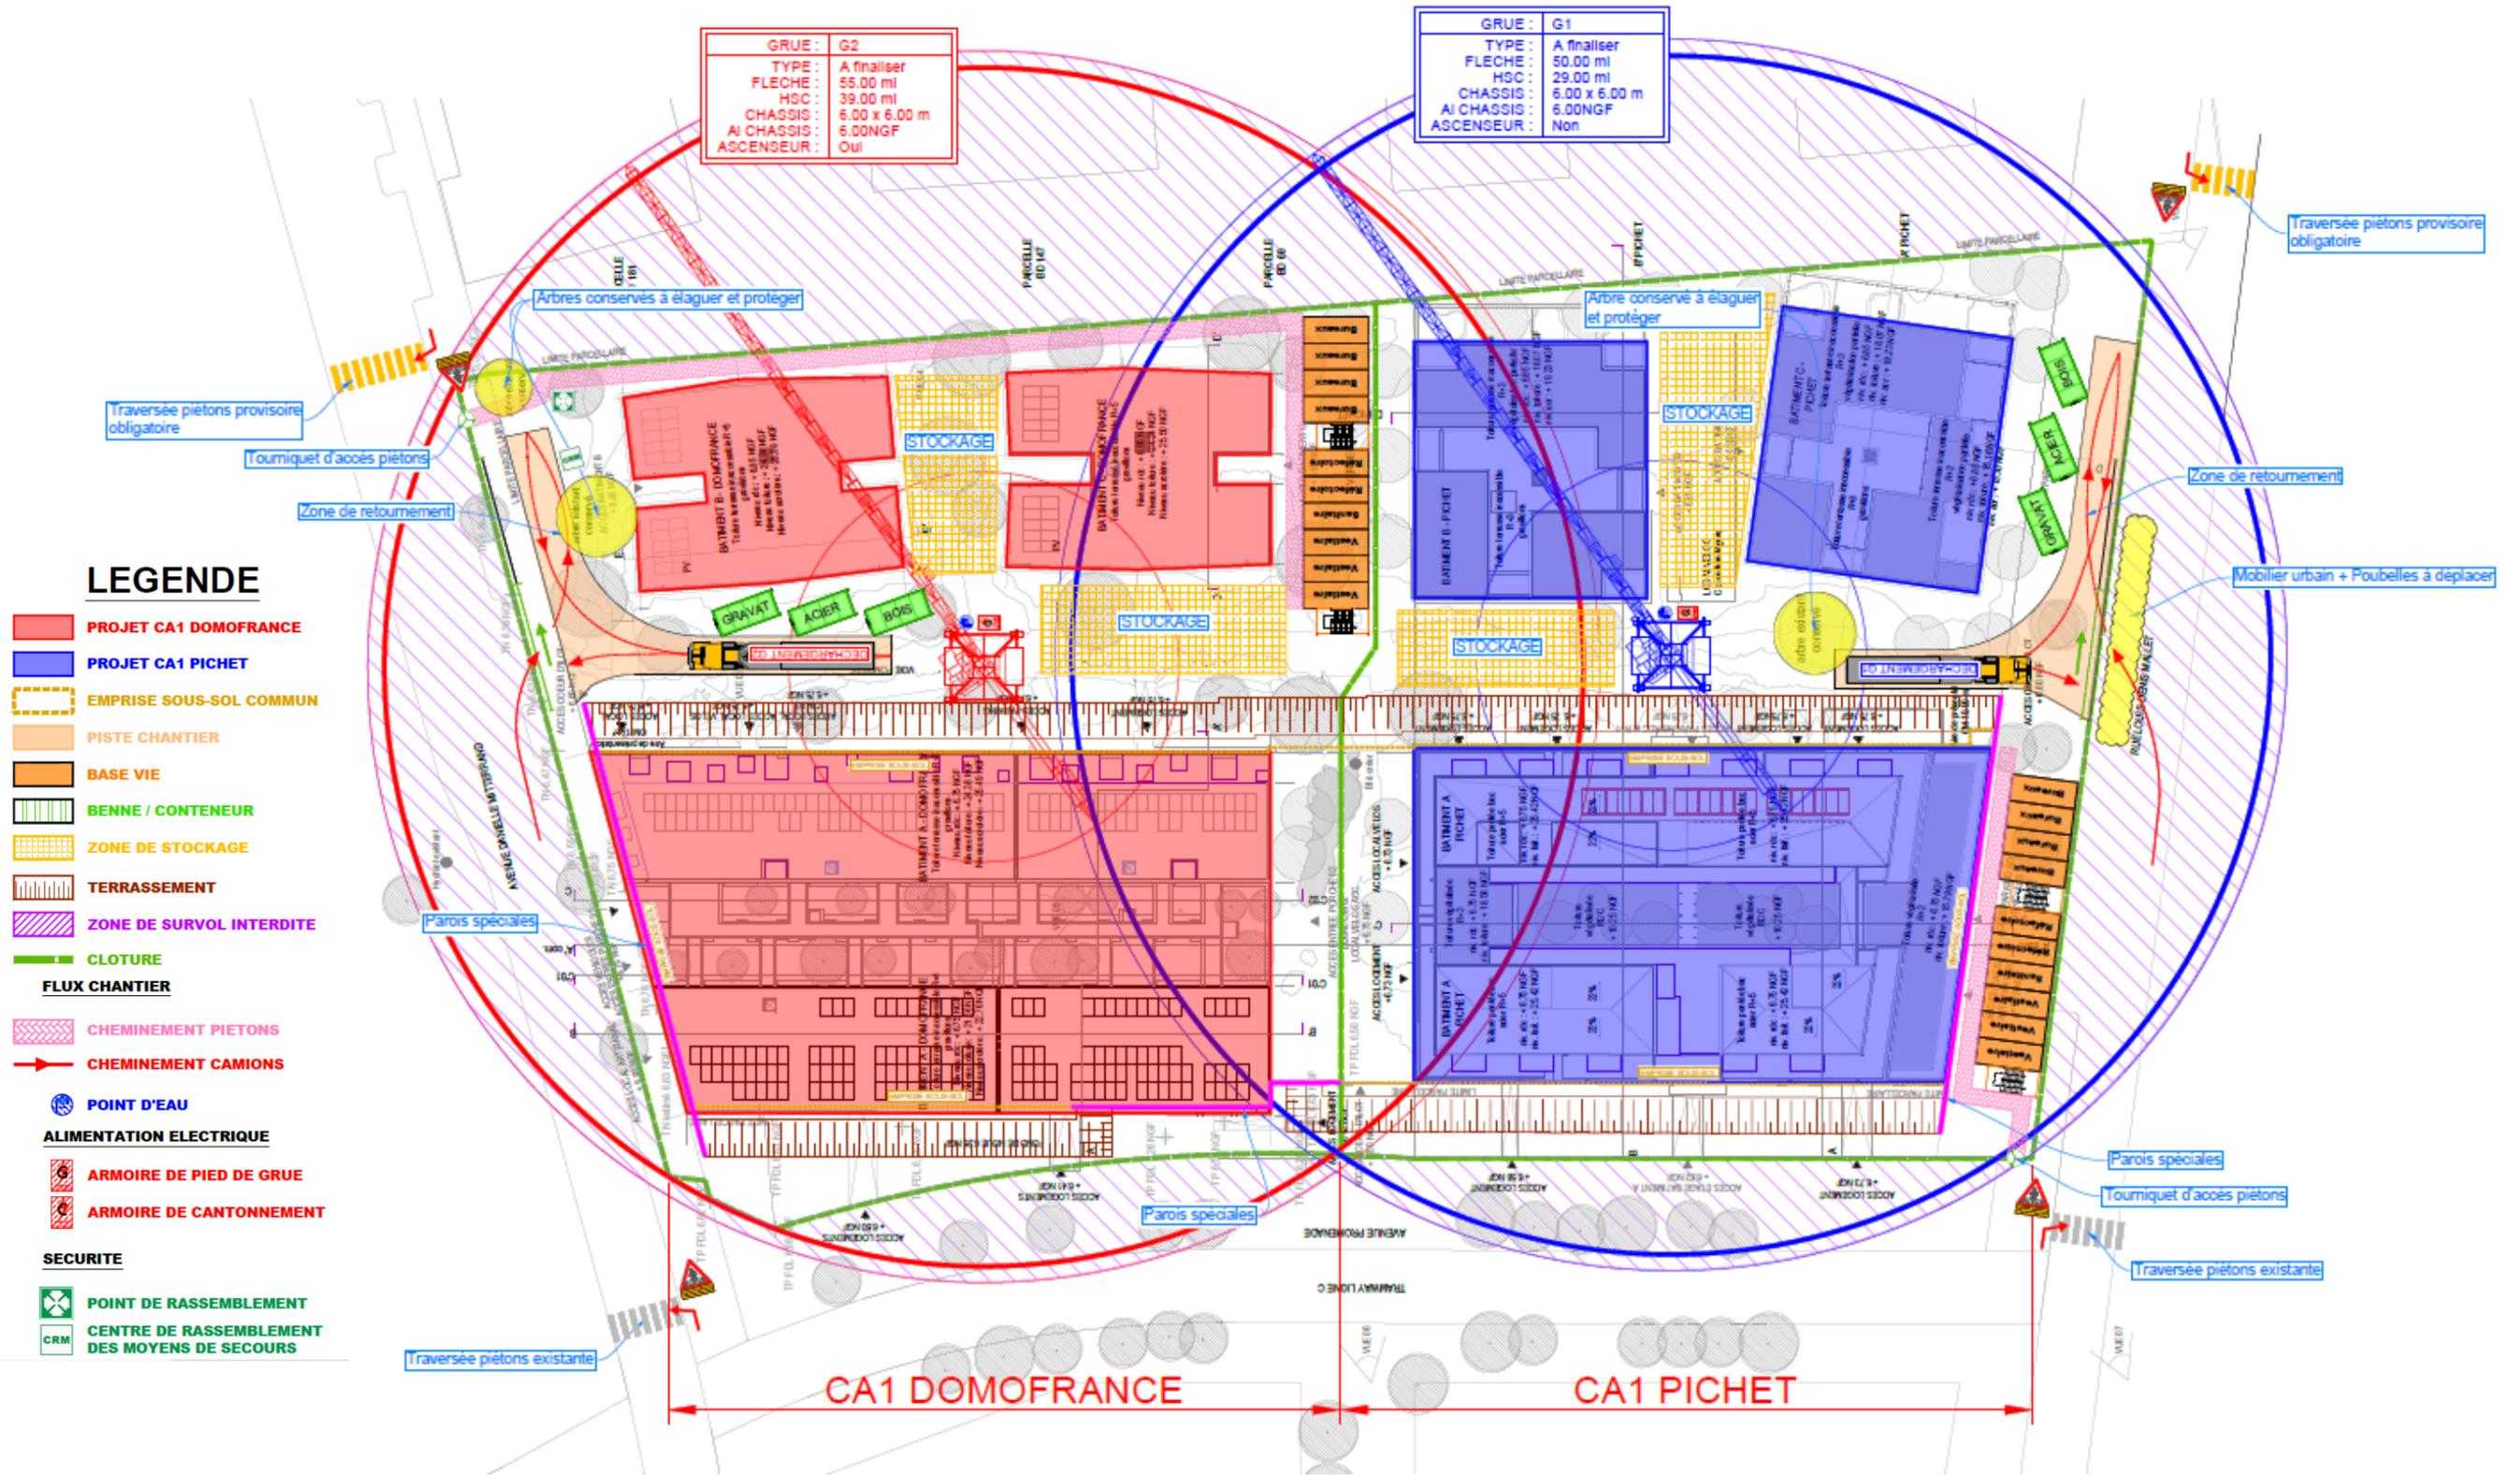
Plan d'installation de chantier (Source : OGEBA Ingénierie)
